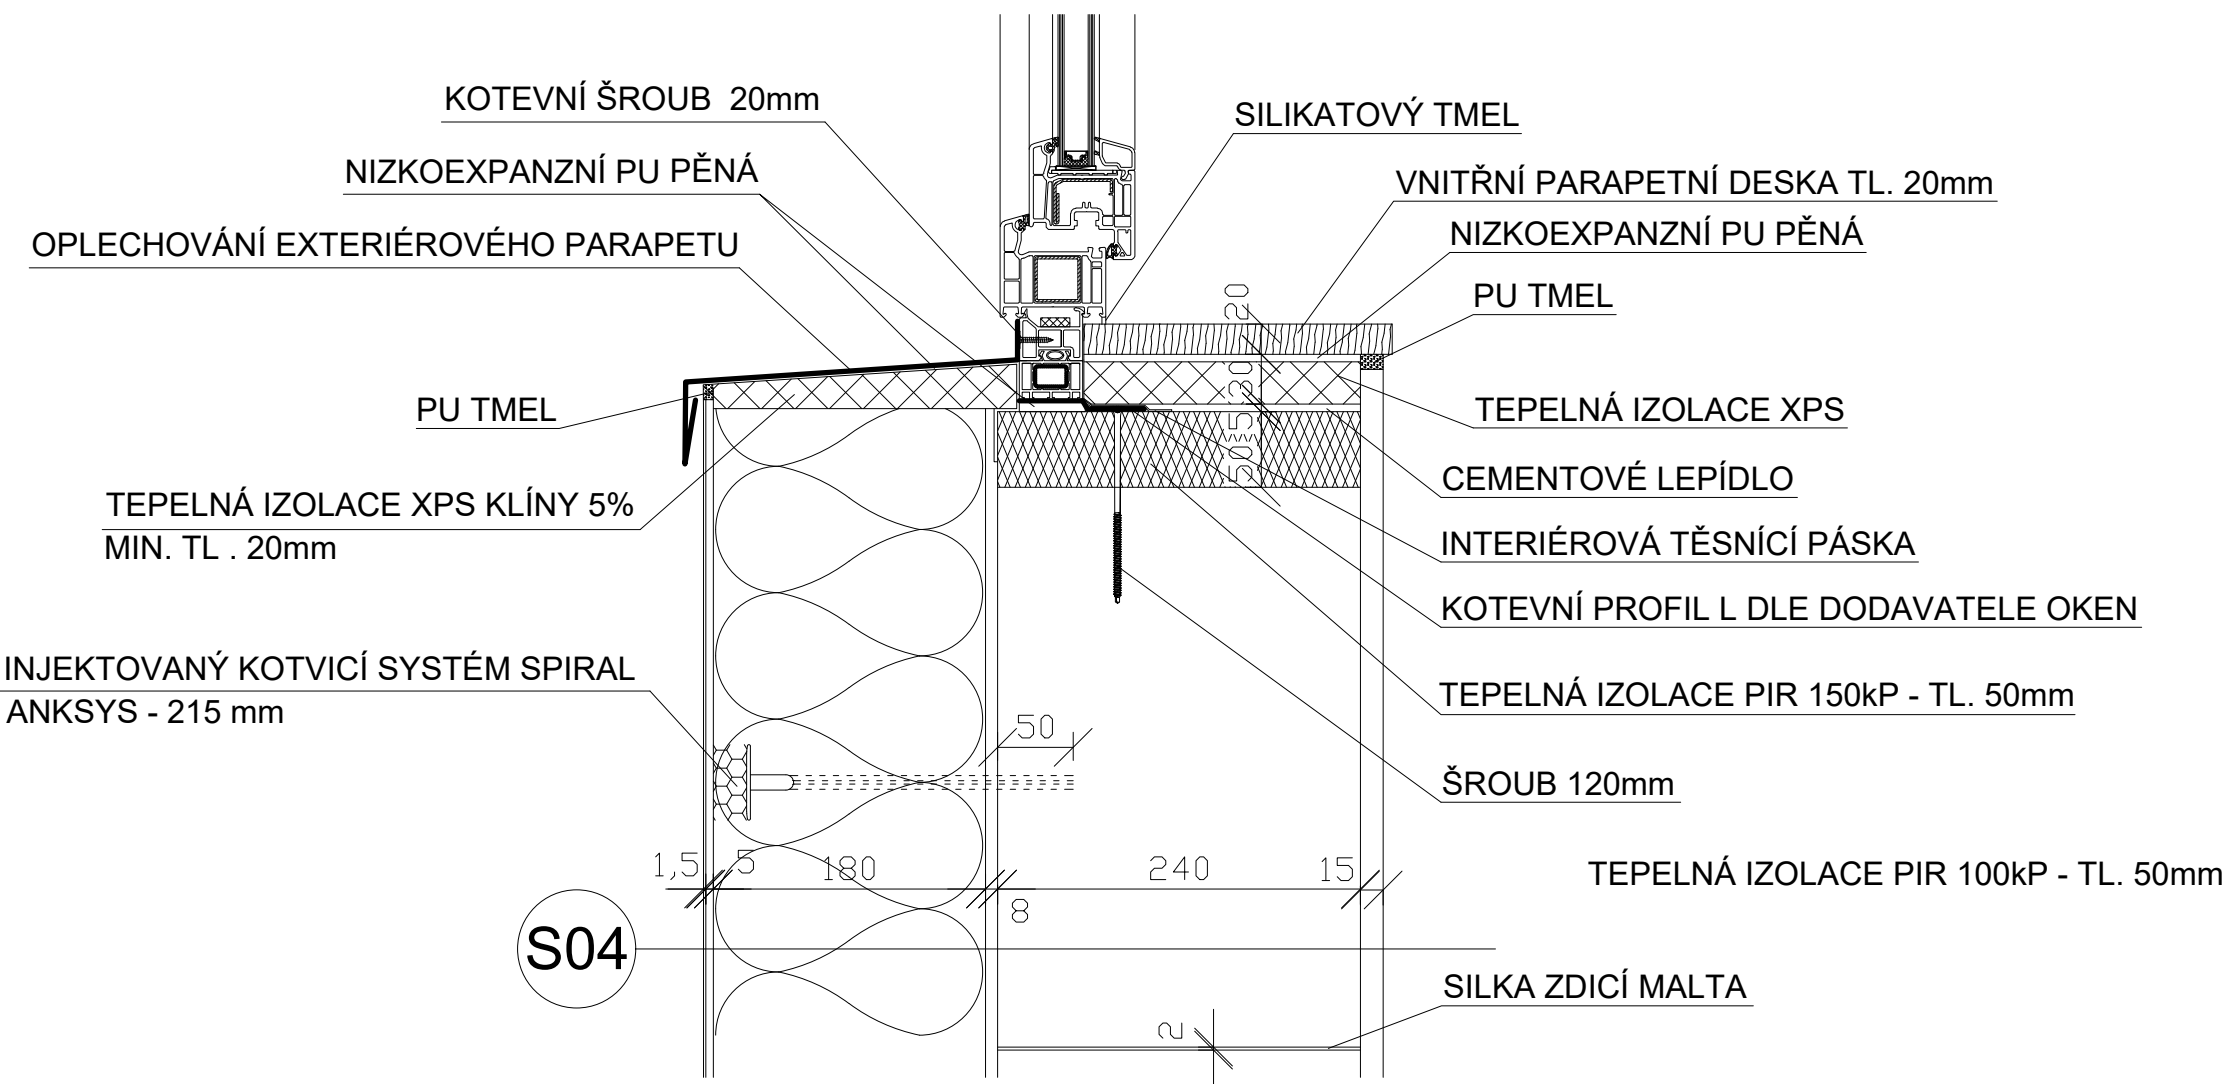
DETAIL OKNA (OSTĚNÍ, NADPRAŽÍ, PARAPET)
